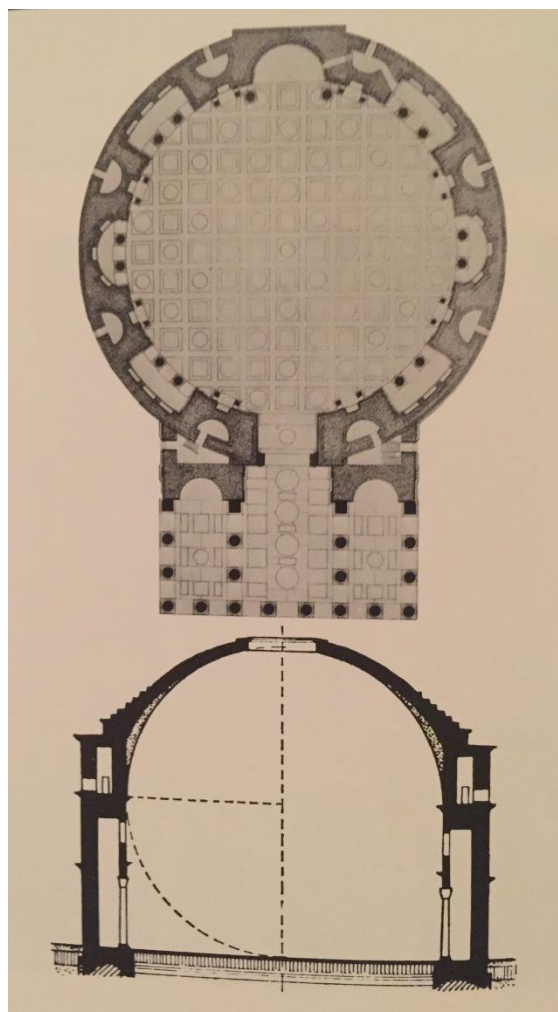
Planta e Secção do Panteão de Roma (Janson, 1989)
